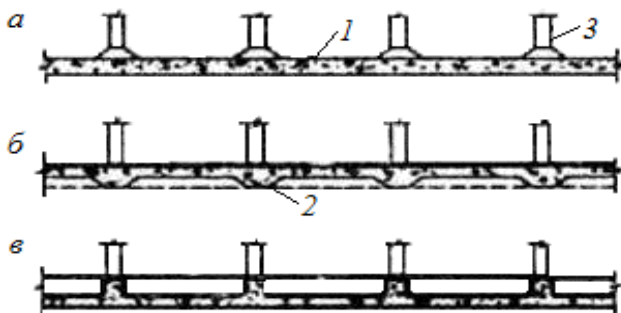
Плитні фундаменти (в розрізі): *а* – суцільна плита; *б* – ребриста плита з ребрами донизу; *в* – те саме, доверху;
